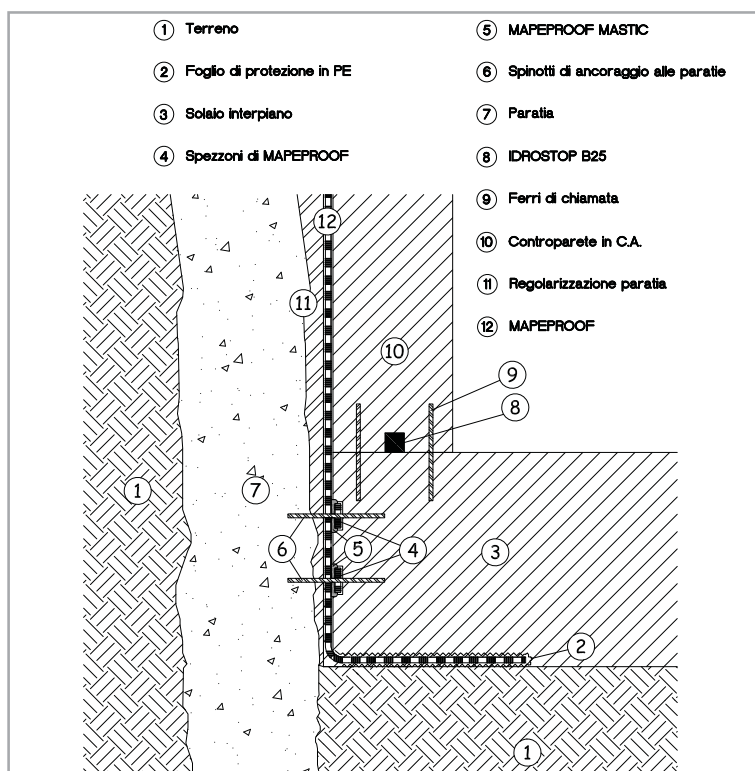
Particolare tecnico dell'impermeabilizzazione della testata di un solaio intermedio di costruzioni in topdown
